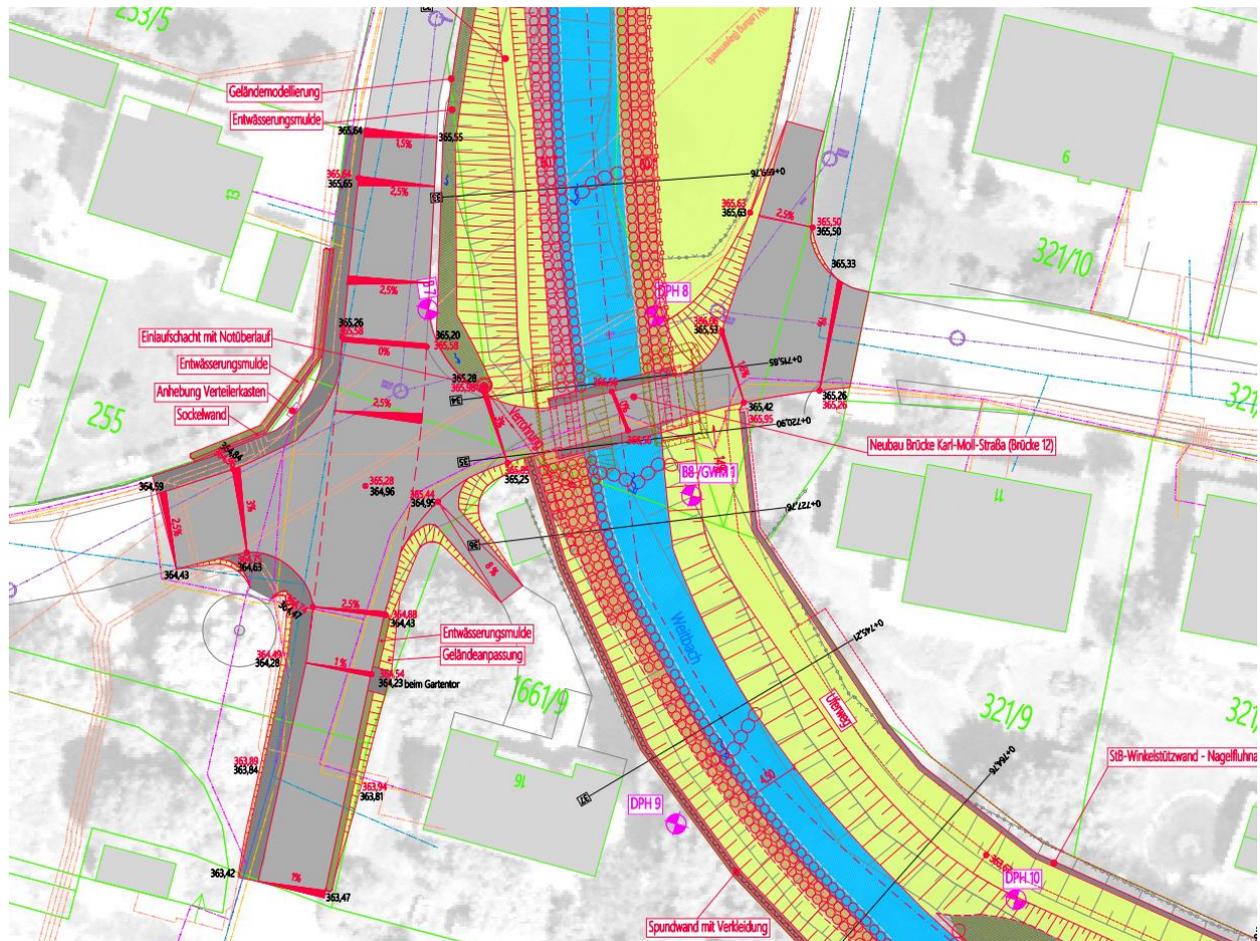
Ausschnitt Lageplan Straßenanpassungen Karl-Moll-Brücke
